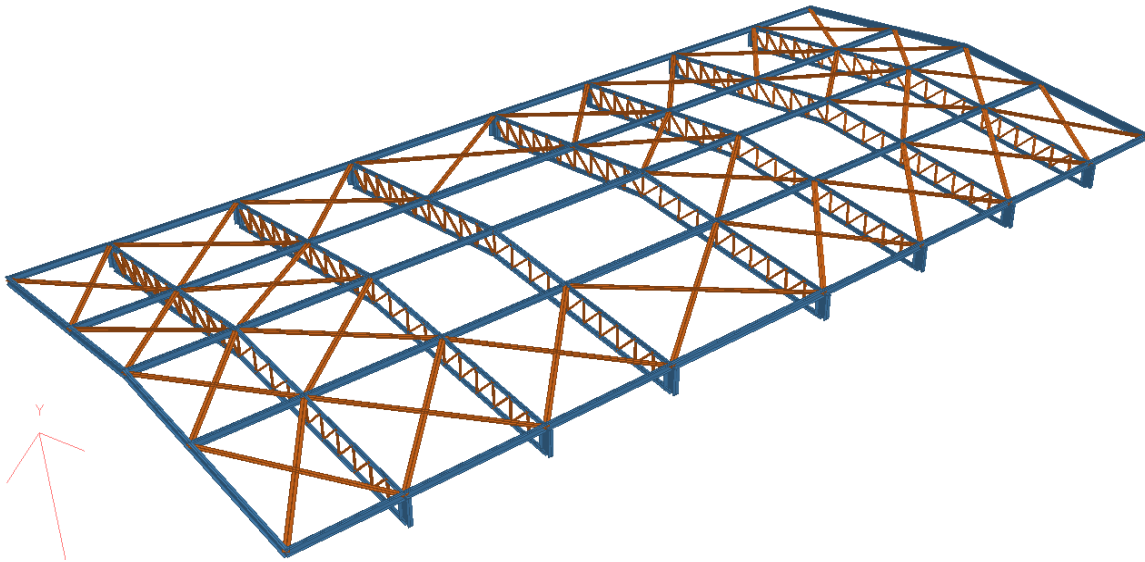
Vista general de la techumbre de la casa de máquinas
